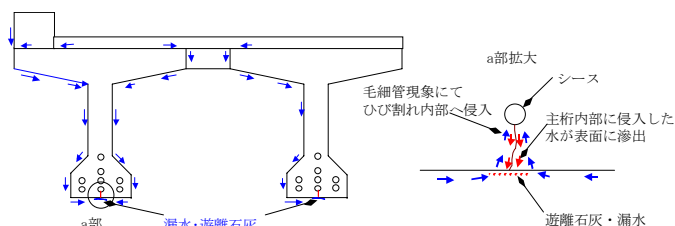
ひび割れ表面の遊離石灰・漏水の発生機構
